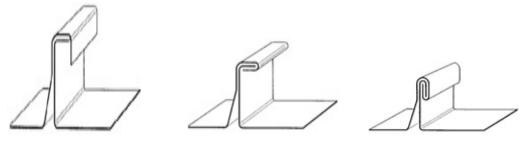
Последовательность изготовления двойного стоячего фальца для металлической крыши
